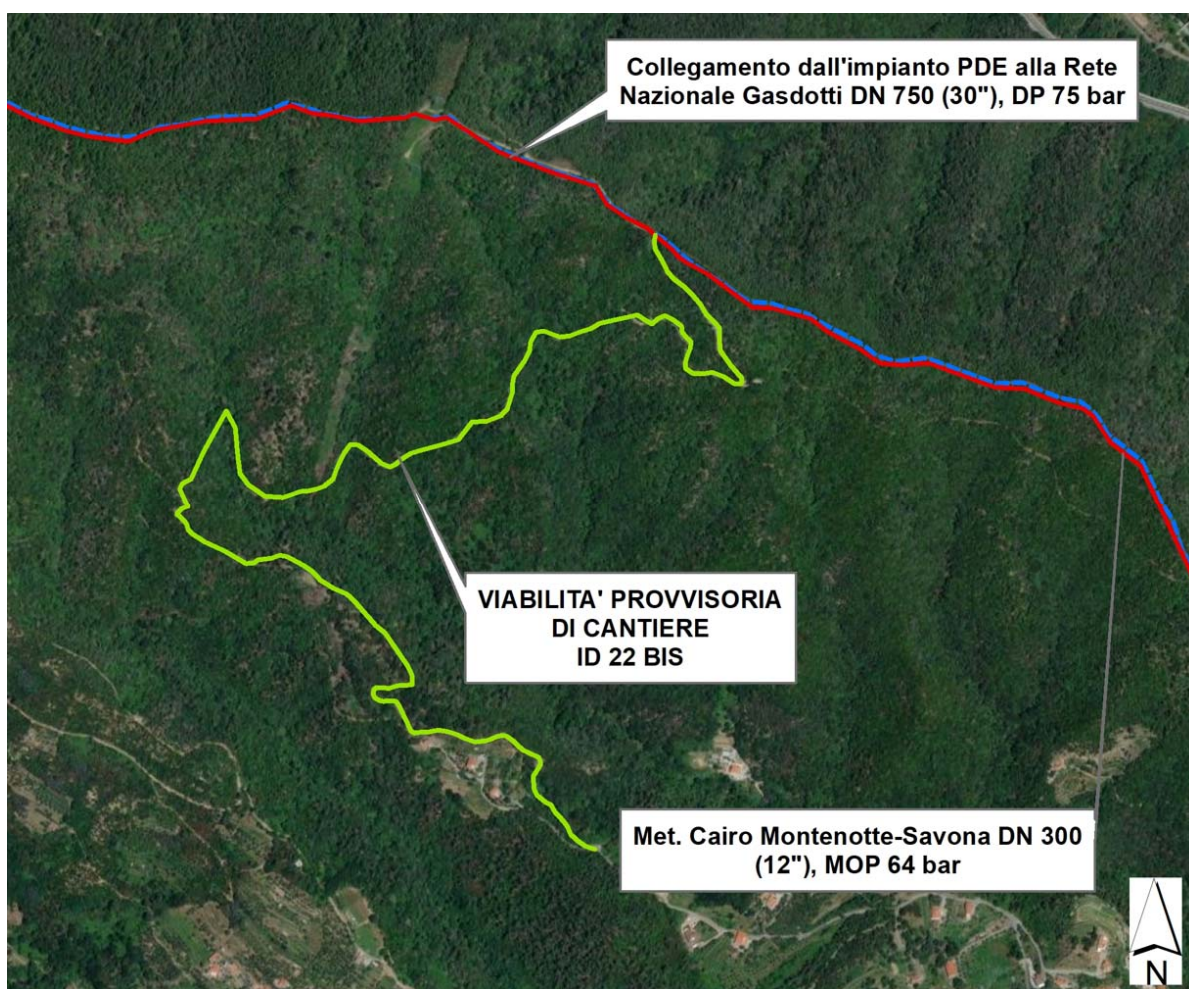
Planimetria di inquadramento della strada provvisoria di cantiere ID22 BIS
